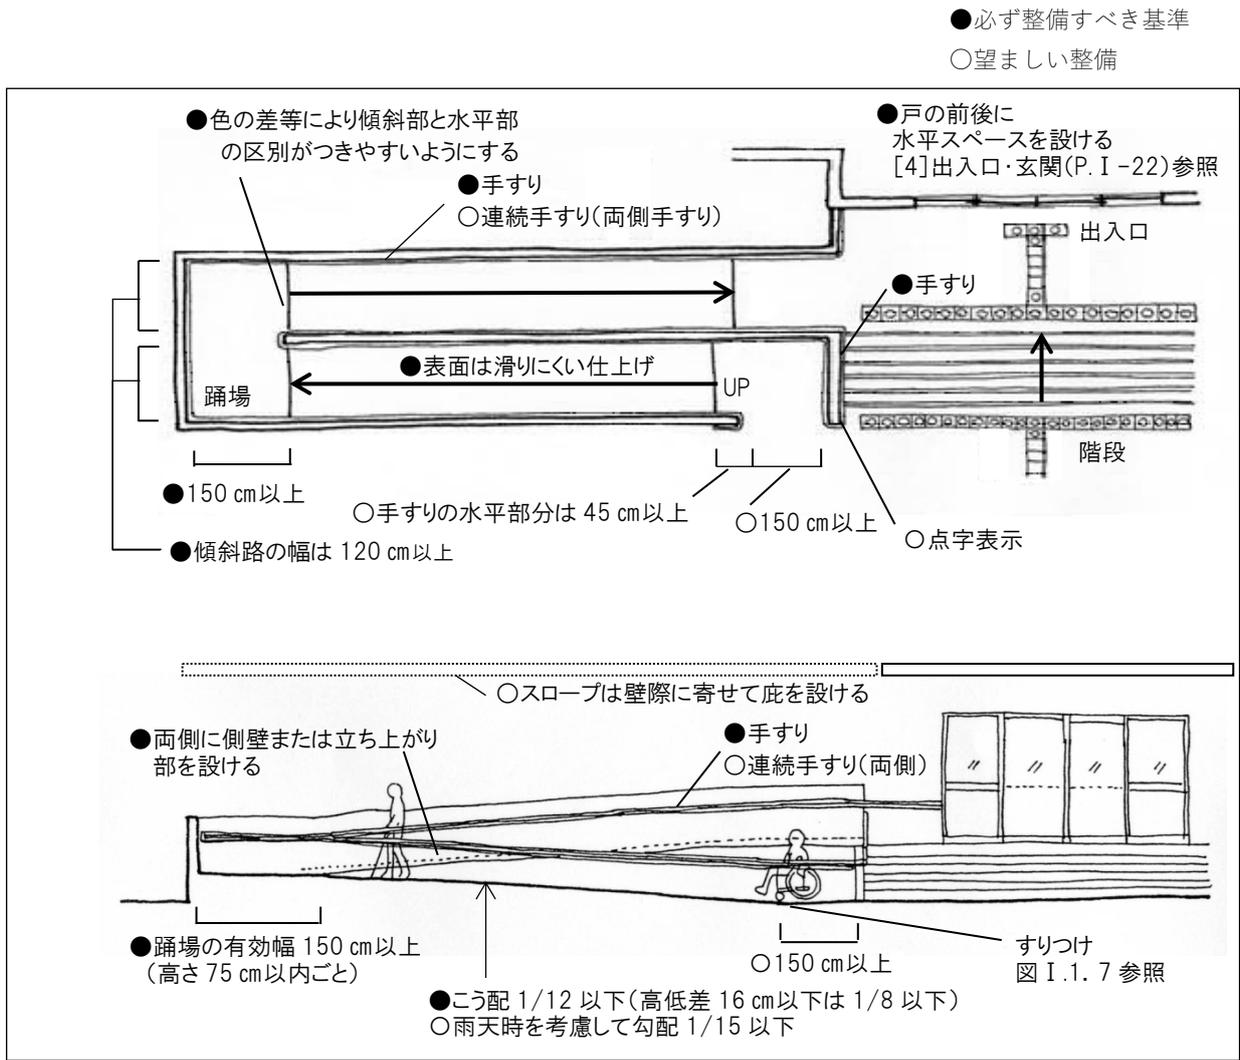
傾斜路の平面図(上)および立面図(下)
